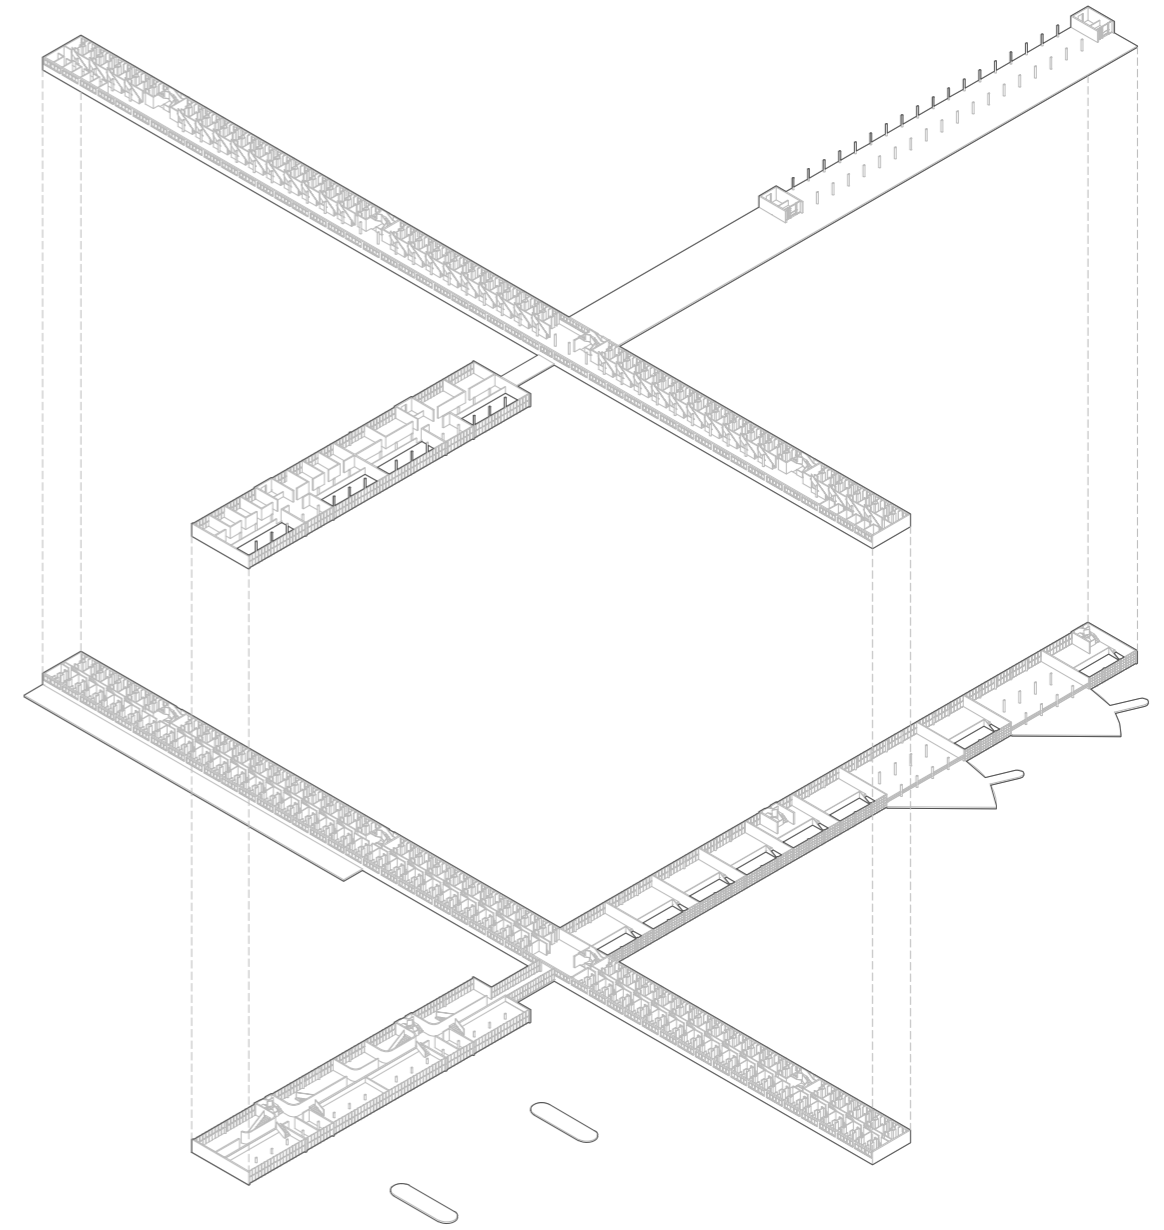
Axonometría seccionada a nivel. Planta cuarta y quinta.
